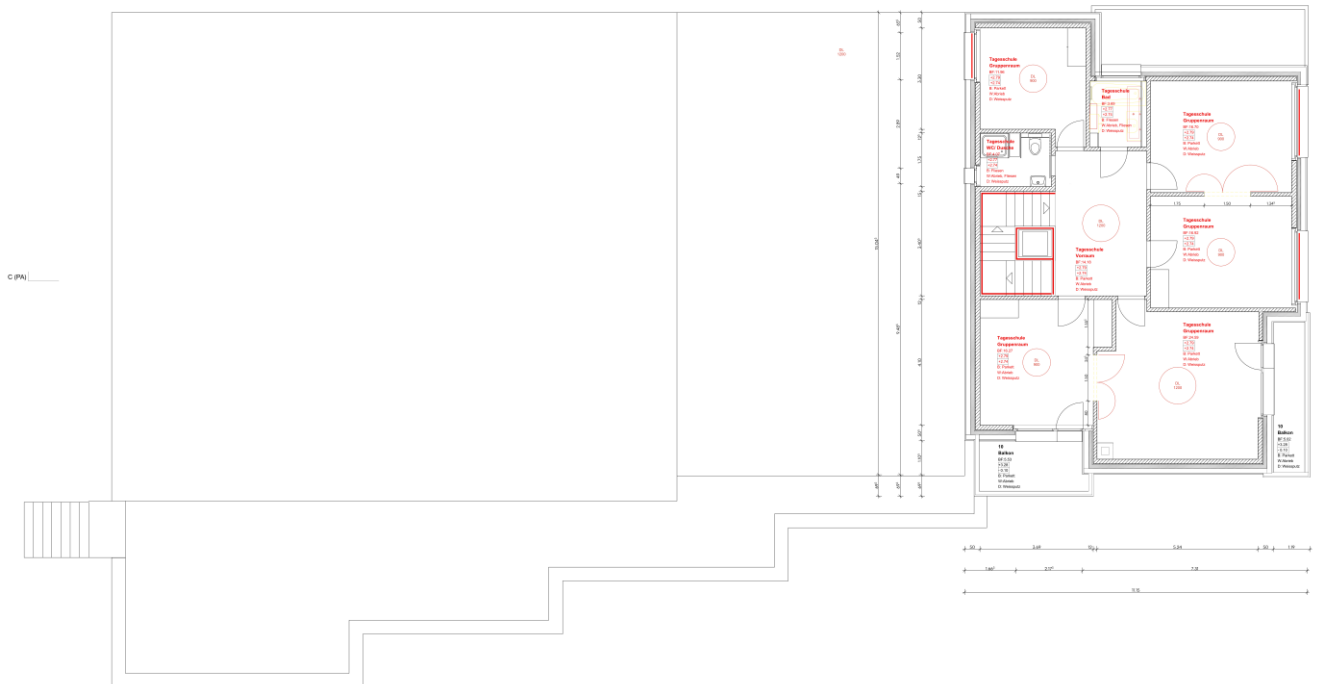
Grundriss 1. Obergeschoss, Gebäude 3
